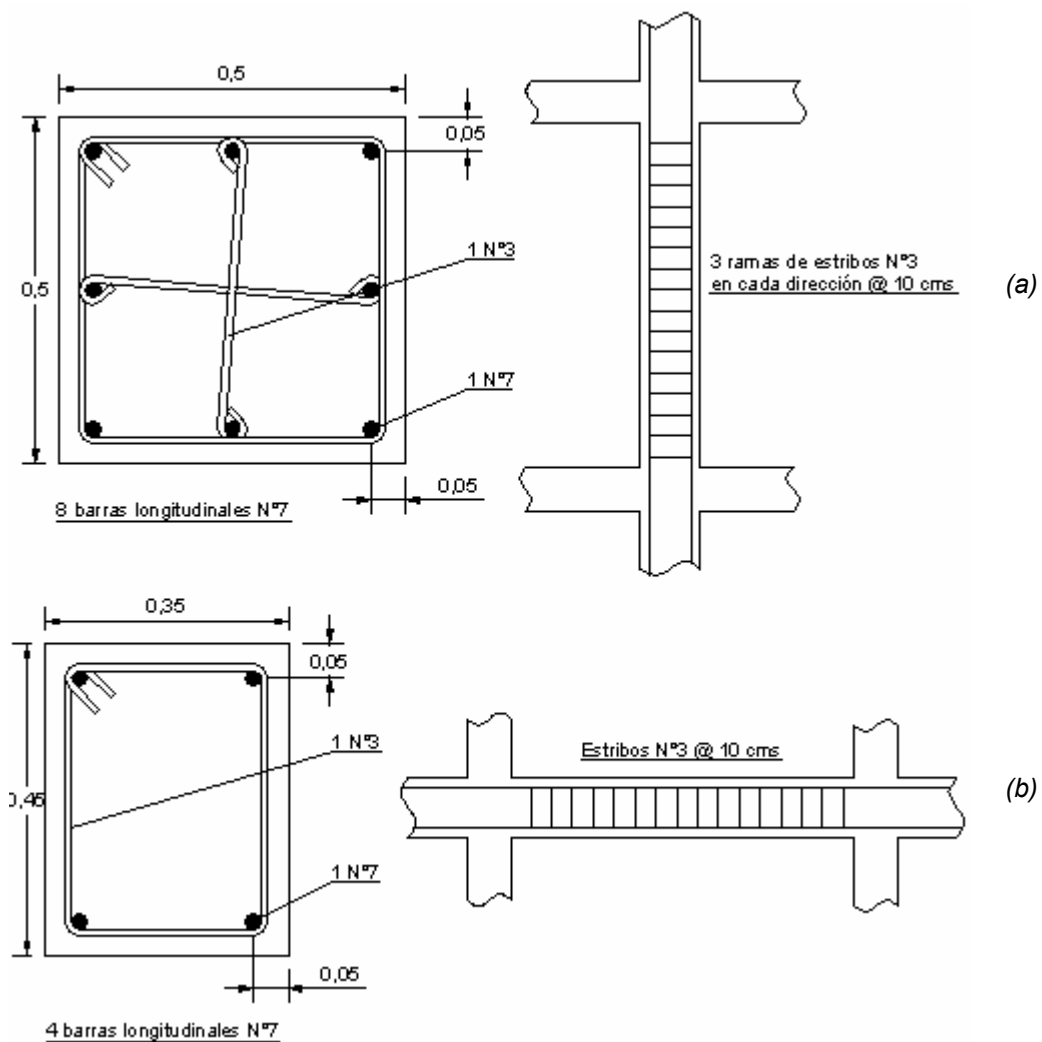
6. Refuerzo longitudinal y transversal: (a) columnas y (b) vigas
